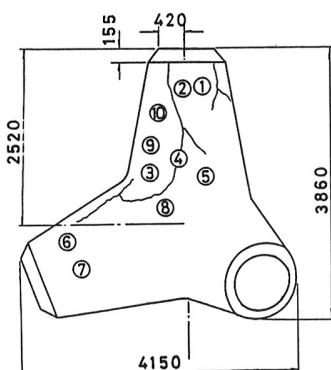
テトラポッドの概略図 写真-2 コアー薄片による
